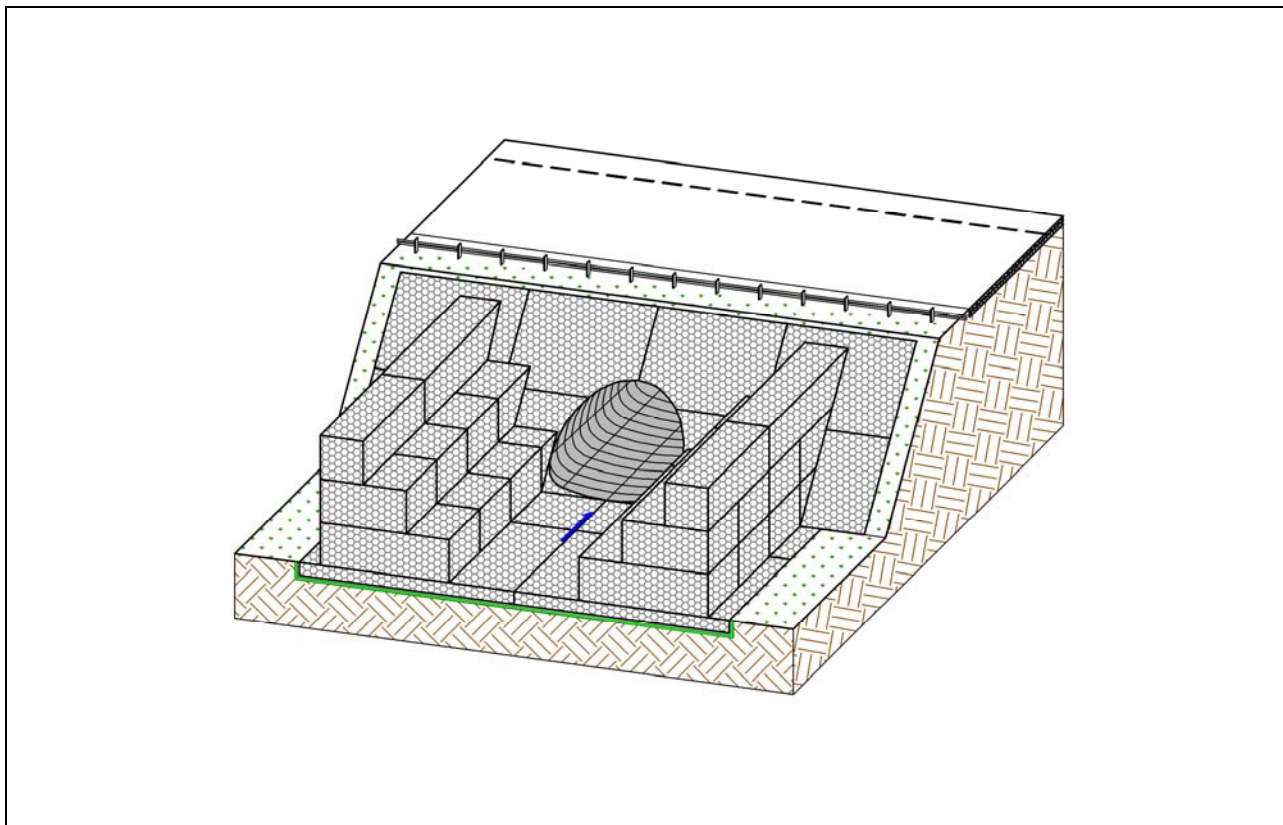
(продолжение) Укрепление дорожных откосов габрионными конструкциями и оголовков водопропускной трубы открьлками из габрионных конструкций
